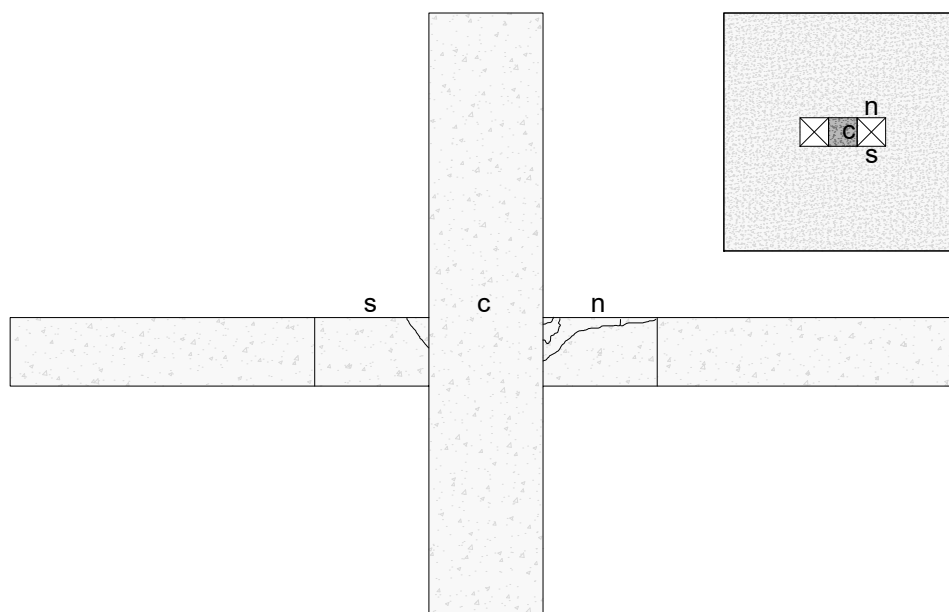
Padrão de fissuração da laje LFE2 - vistas abertura
